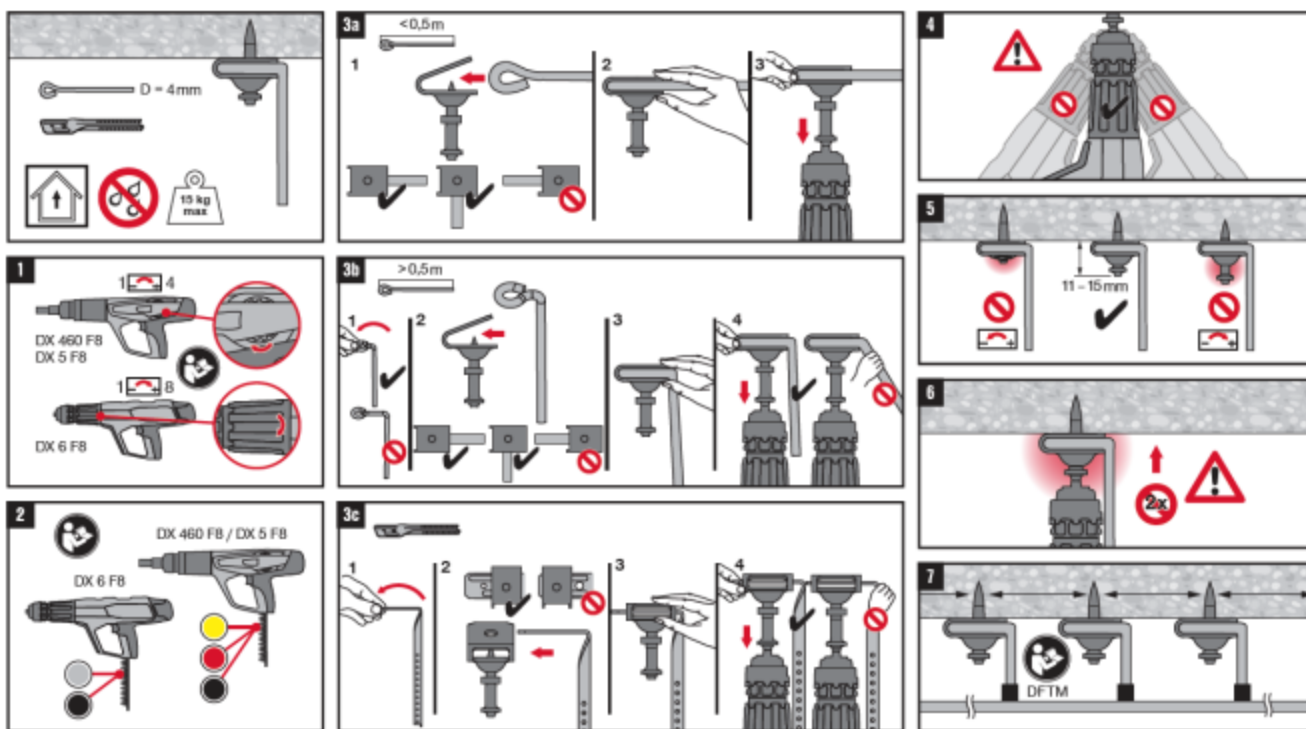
Instructions d'installation en utilisant les systèmes X-SCO et NALH37
